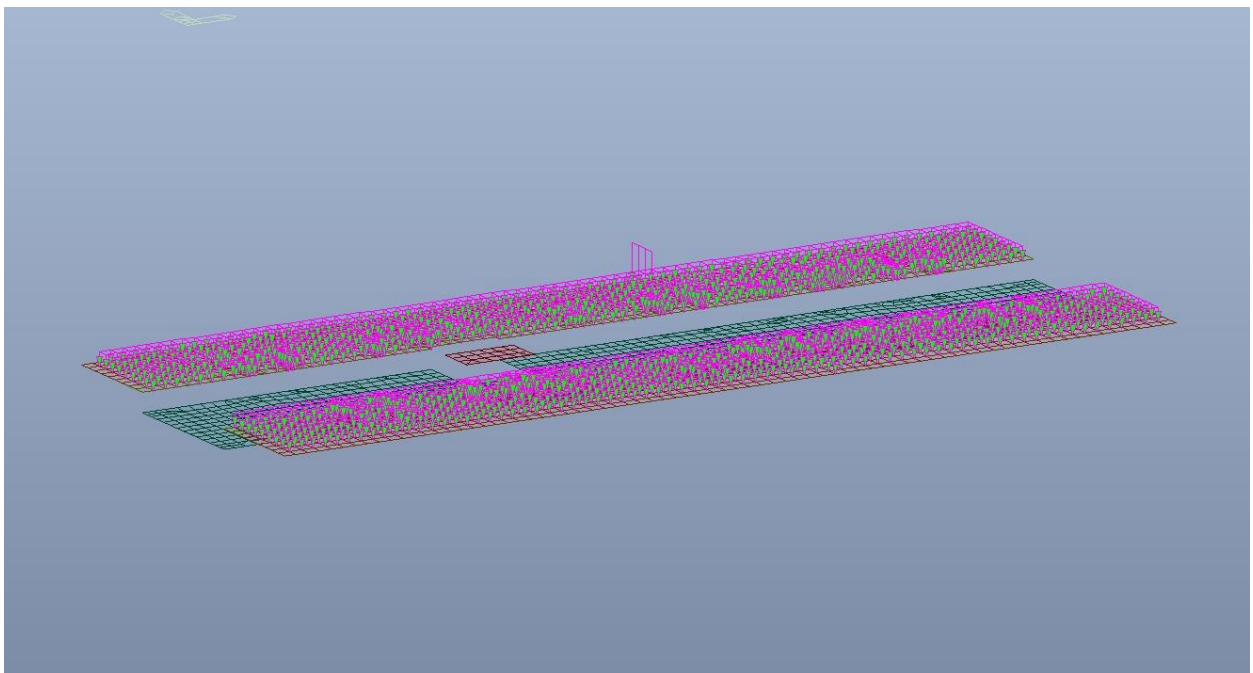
Platea di fondazione – Carichi permanenti NON strutturali  $G_2$
